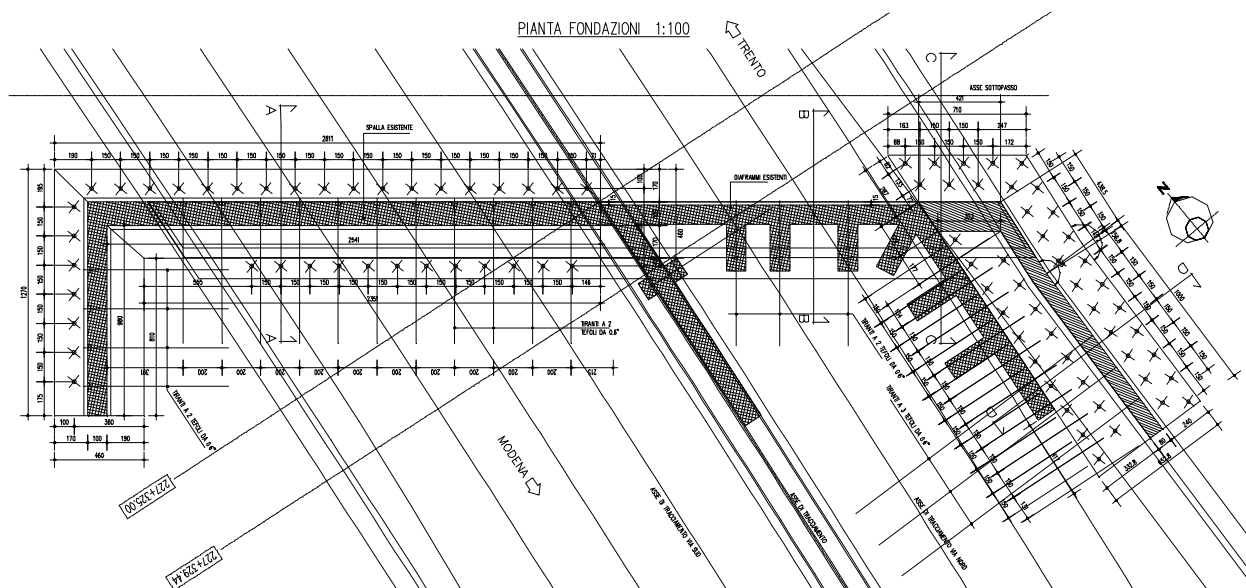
Spalle - Pianta delle fondazioni
